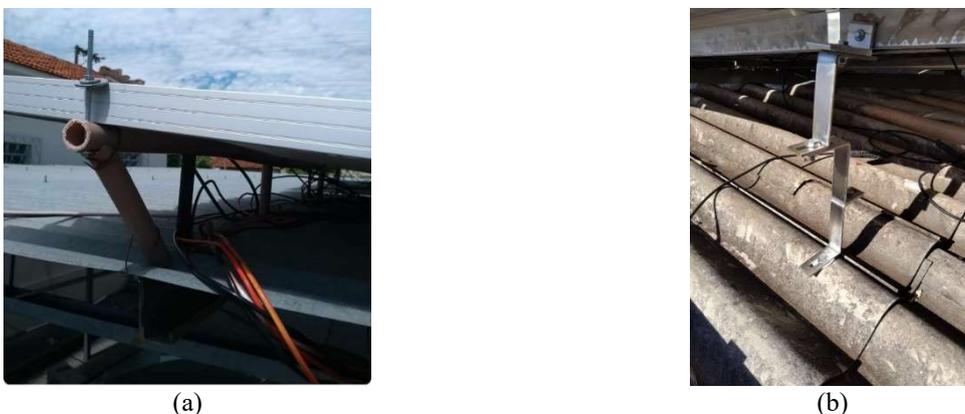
(a) Estrutura improvisada com canos de PVC e (b) estrutura improvisada com componentes de outra estrutura.
